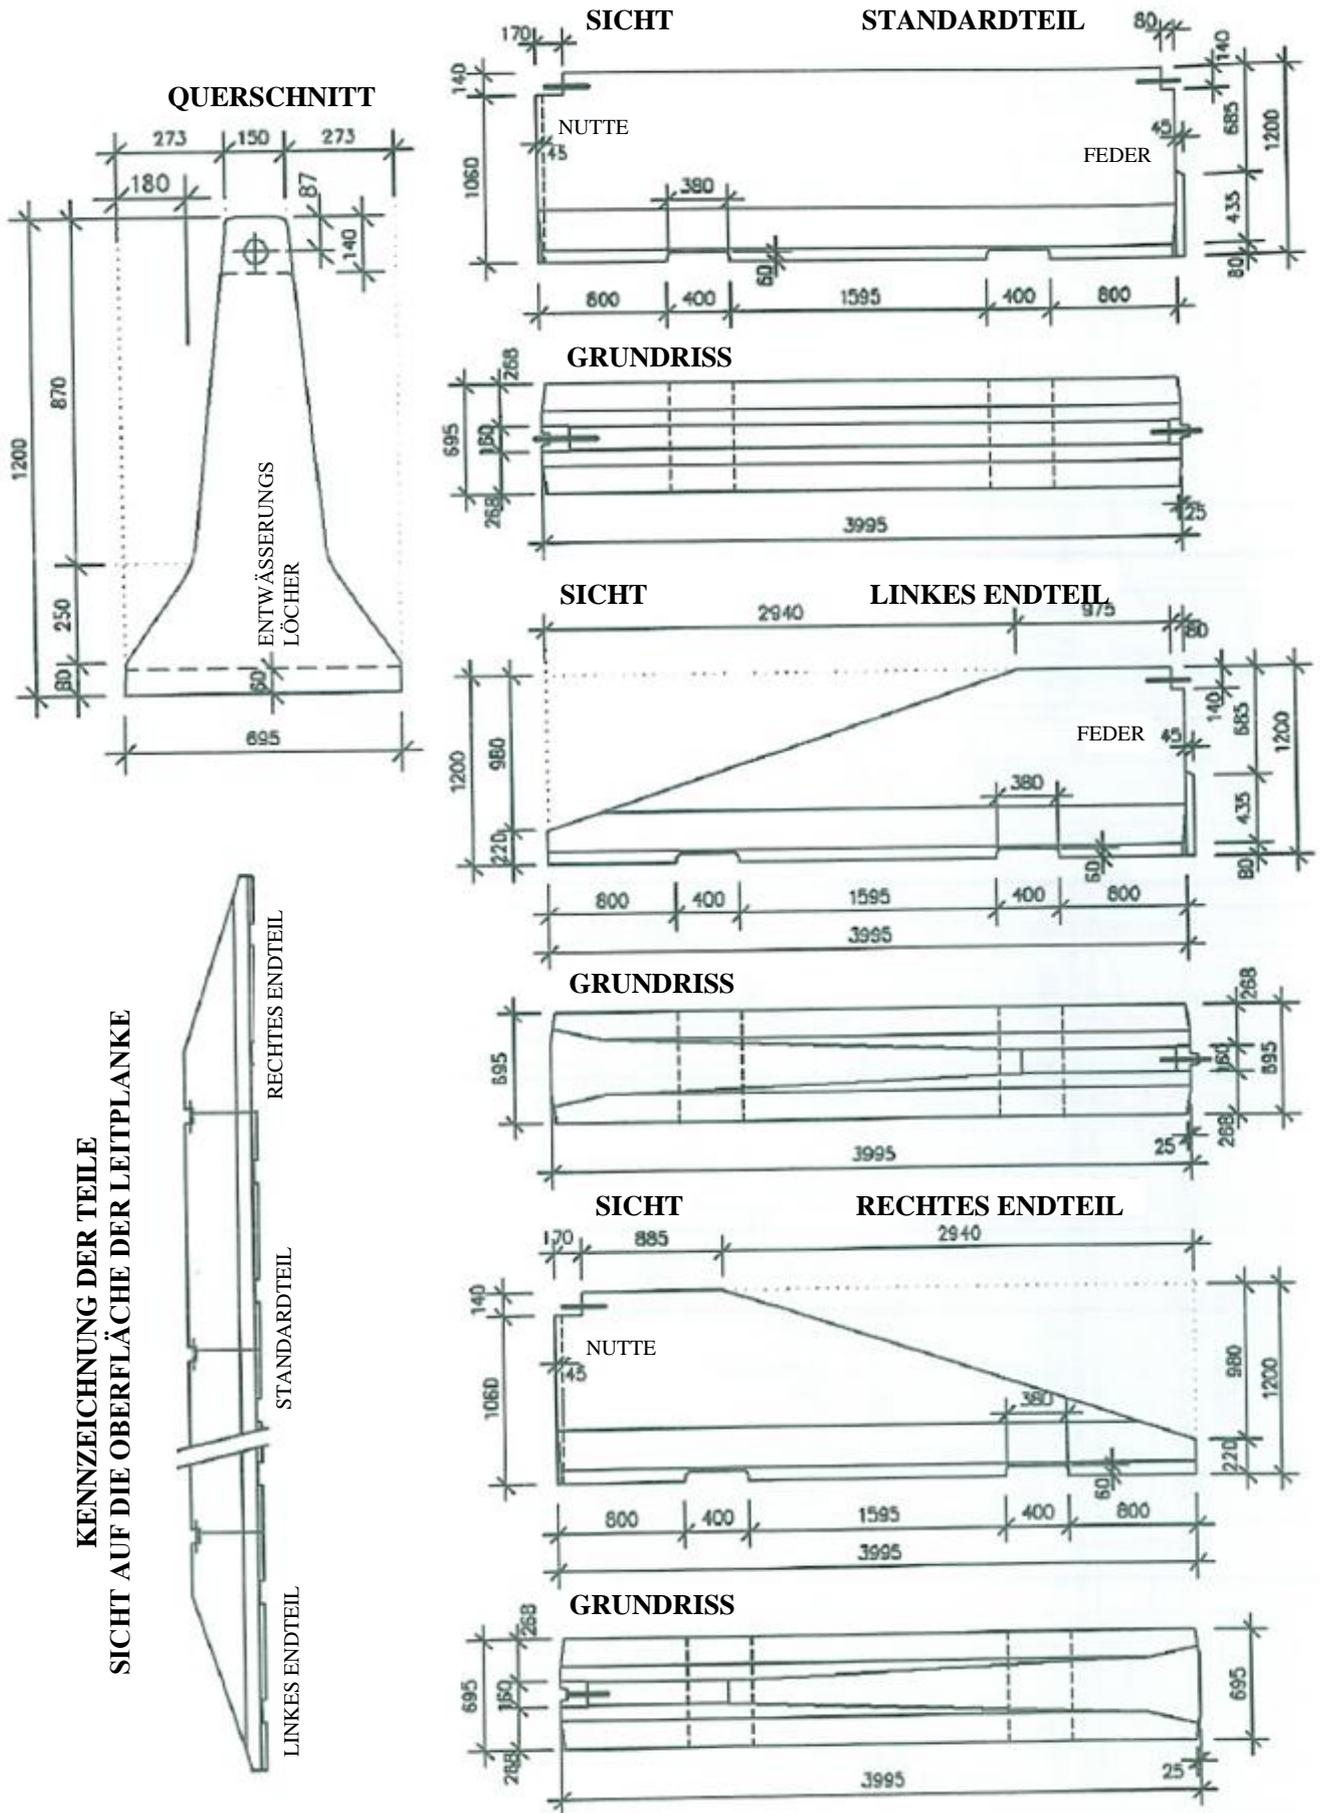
beidseitige Betonleitplanke 1,2 m hoch - Standard- und Endteil
